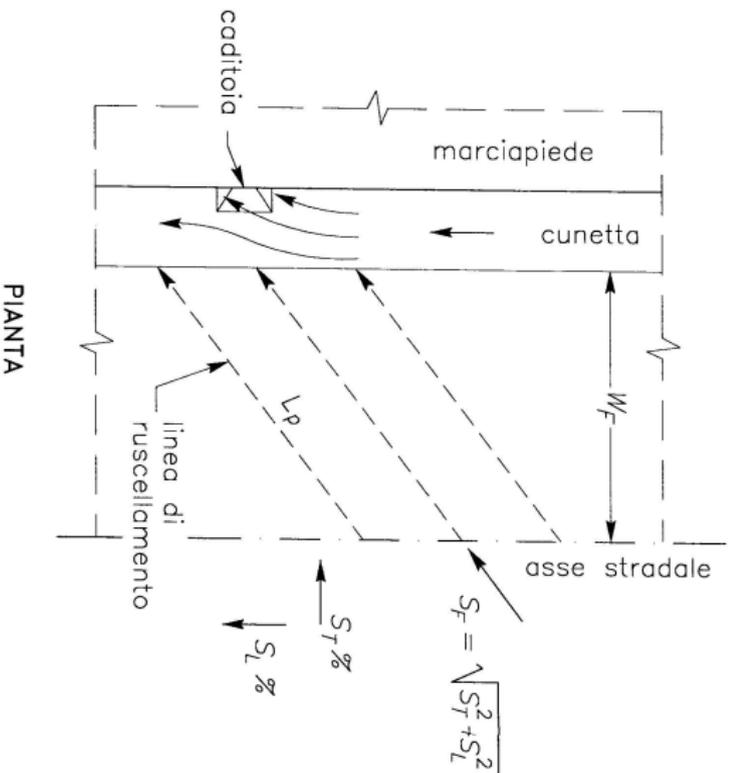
Ruscellamento stradale nel caso di strade con pendenze longitudinale e trasversale diverse da zero.
